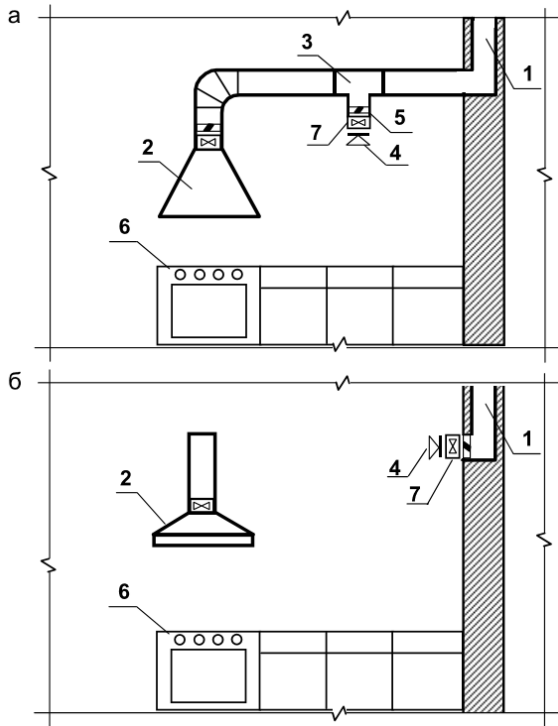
Схемы подключения кухонных вытяжек к вентиляционным каналам:
